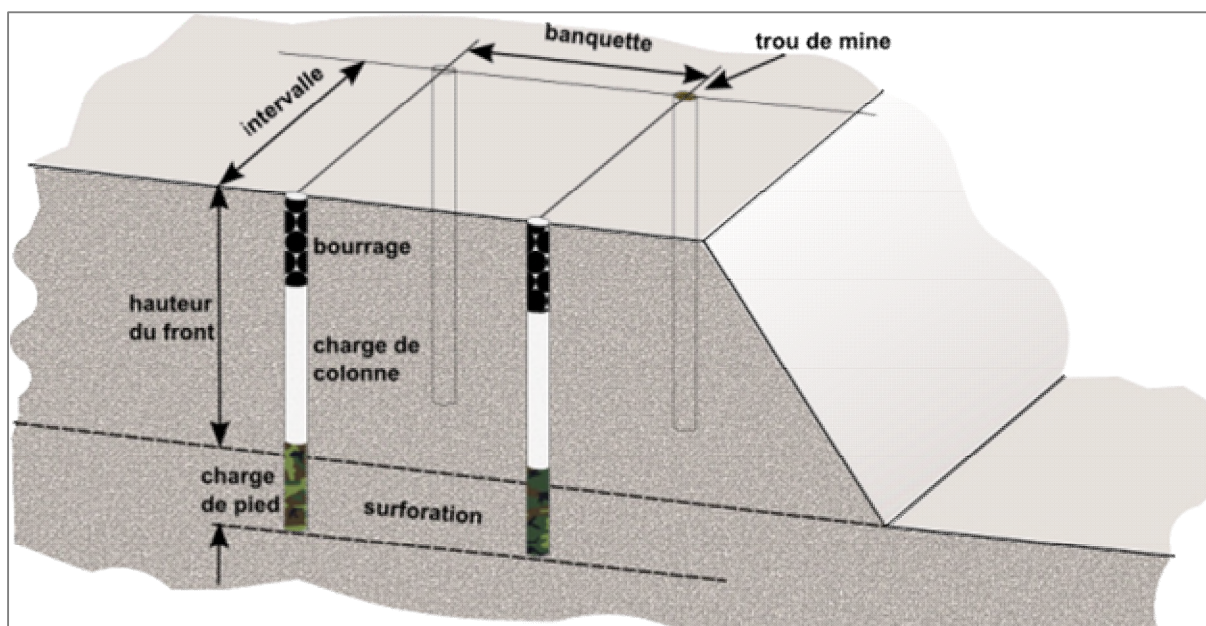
Paramètres géométriques d'un plan de tir (Tout pour le forage, 2019)
